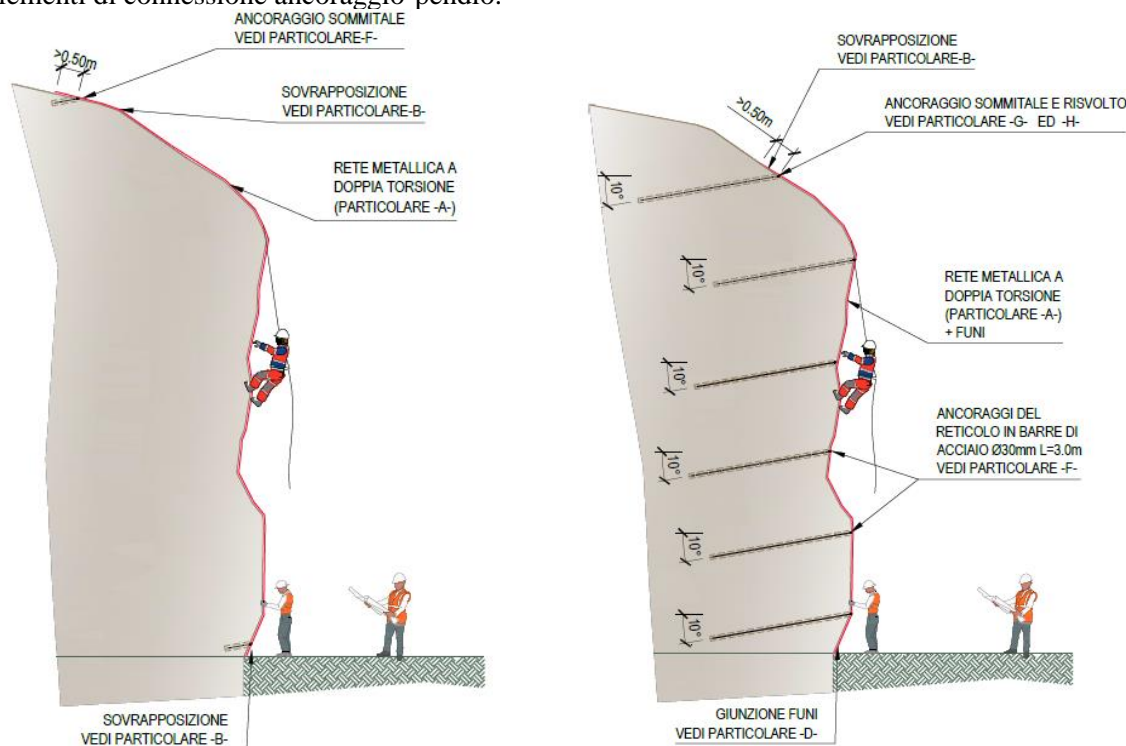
Sezione tipo rivestimento in rete semplice (a sx) e in reti rinforzate con funi (a dx)
